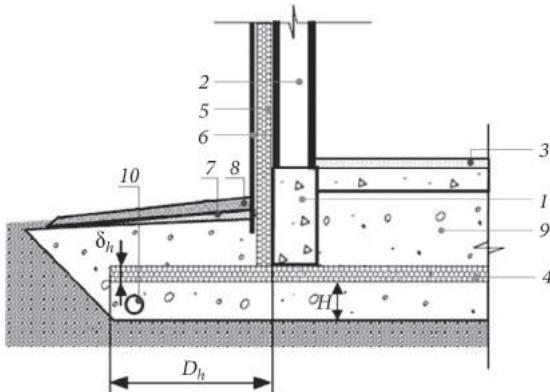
Схема укладки теплоизоляции в фундаментах зданий с переменным режимом эксплуатации: 1 — фундамент; 2 — стена здания; 3 — пол здания; 4 — горизонтальная теплоизоляция (XPS плиты); 5 — вертикальная теплоизоляция (XPS плиты); 6 — защитный слой; 7 — песчаная подготовка под отмостку; 8 — асфальтовая или бетонная отмостка; 9 — непучинистый грунт; 10 — дренаж
